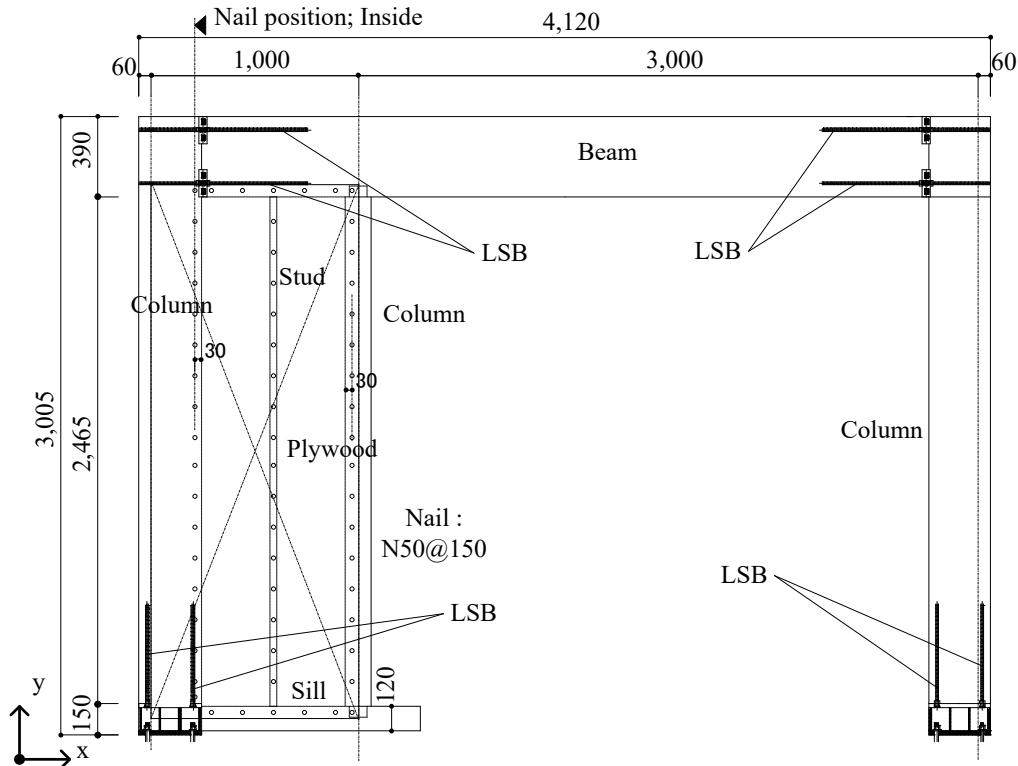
Half 試験体概要図 (Specimen of Half)
